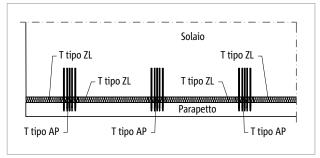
Schöck Isokorb® T tipo AP: disposizione verticale, pianta del parapetto anteposto
